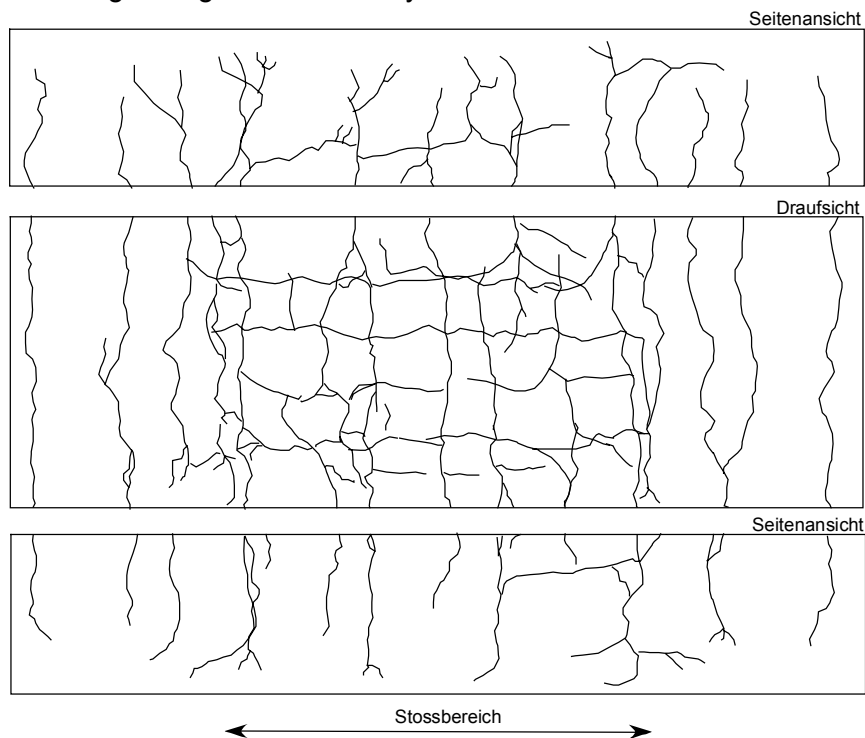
Rissbild Versuchskörper mit einbetoniertem Bewehrungsstoß
